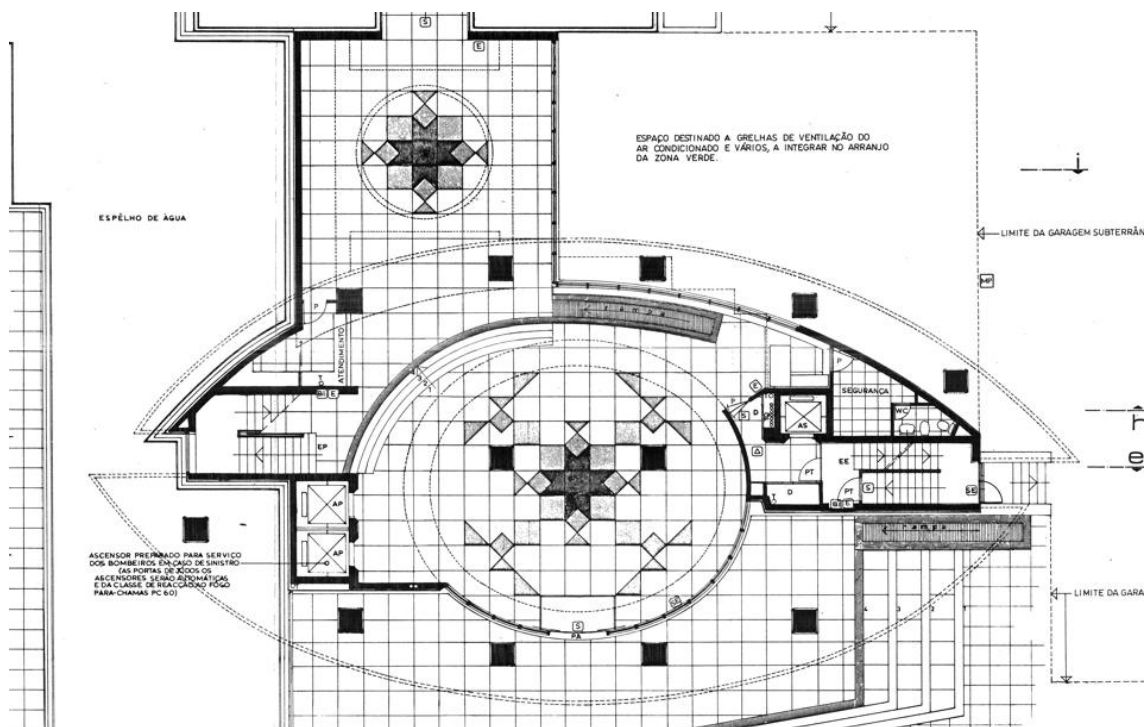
2 - Planta de arquitetura do rés-do-chão
